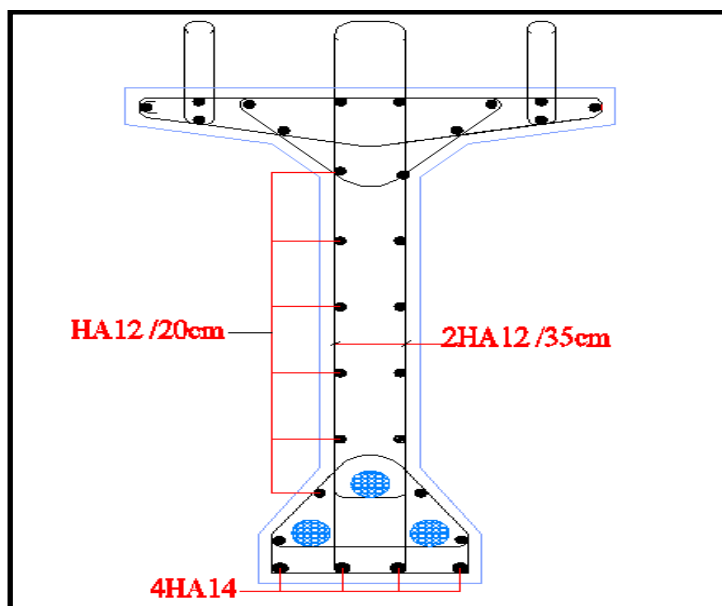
Ferrailage d'une poutre précontrainte (section médiane)
